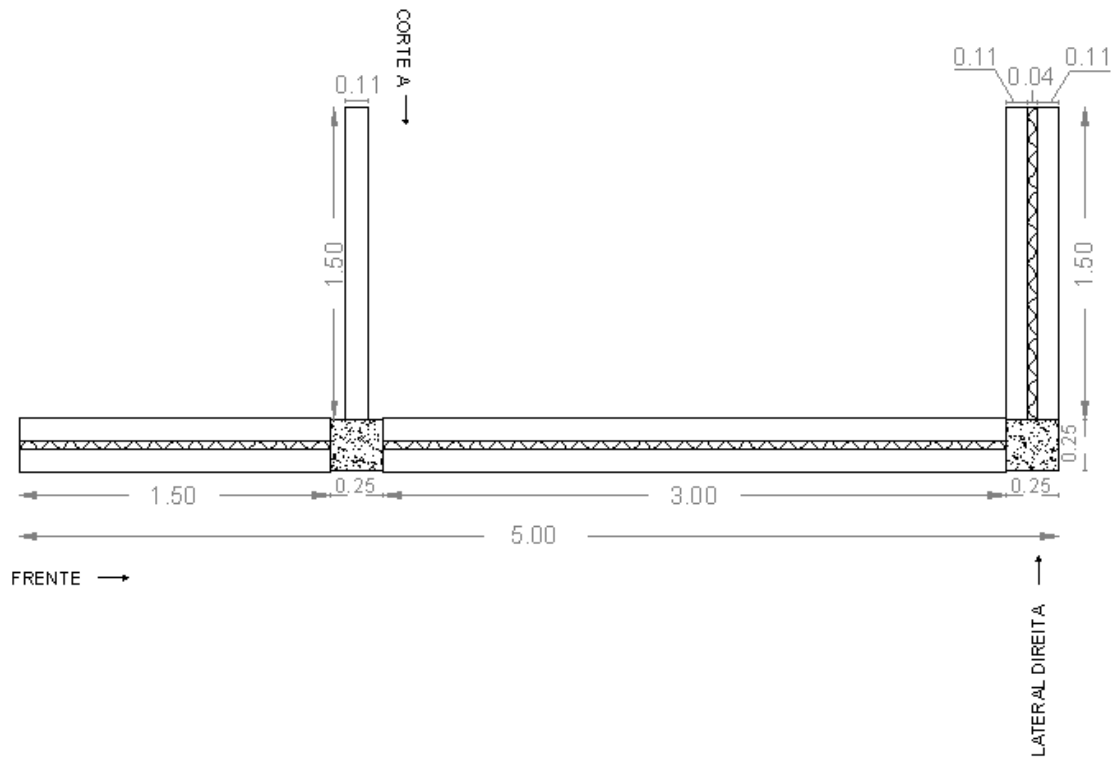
Planta do módulo em paredes de alvenaria dupla.
